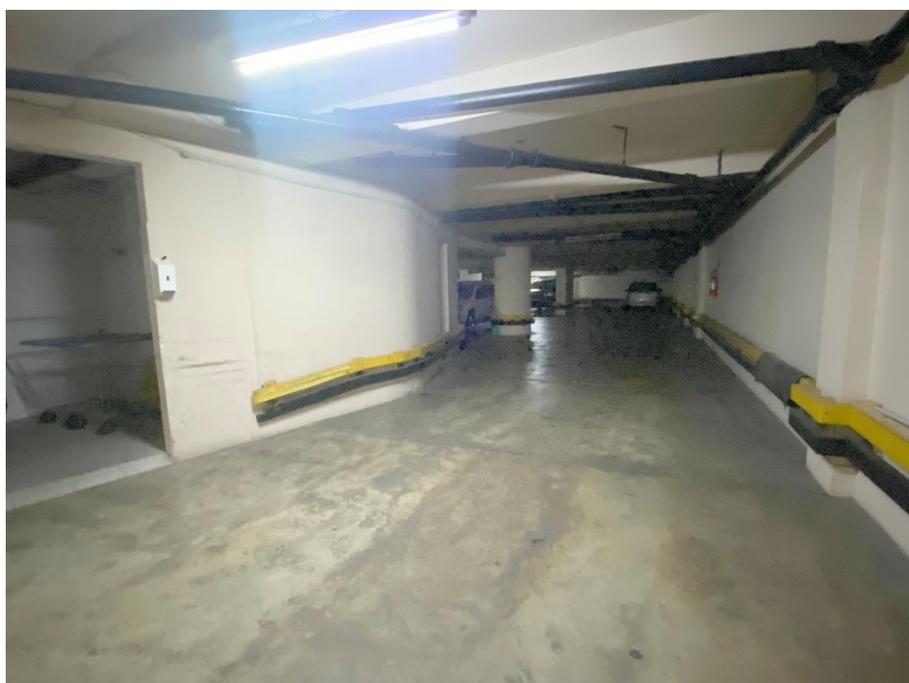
a 25. Vistas gerais da garagem do subsolo do Ed. Moreira Salles.
